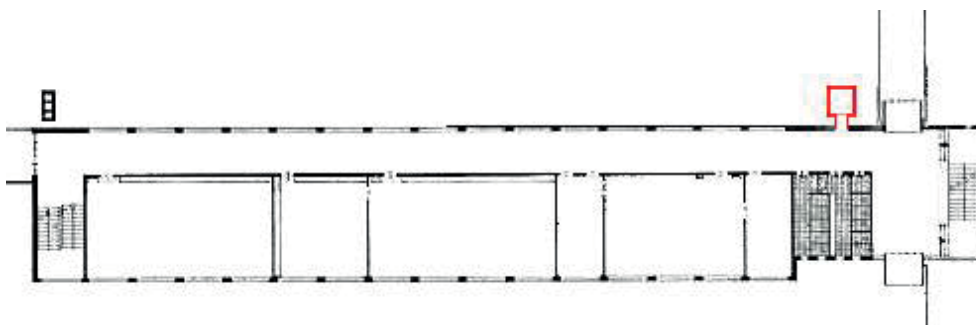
Schulhaus Statthaltergut. Grundriss Erdgeschoss mit möglicher Positionierung eines Liftes (rot). Konzept: Veronika Niederhauser
